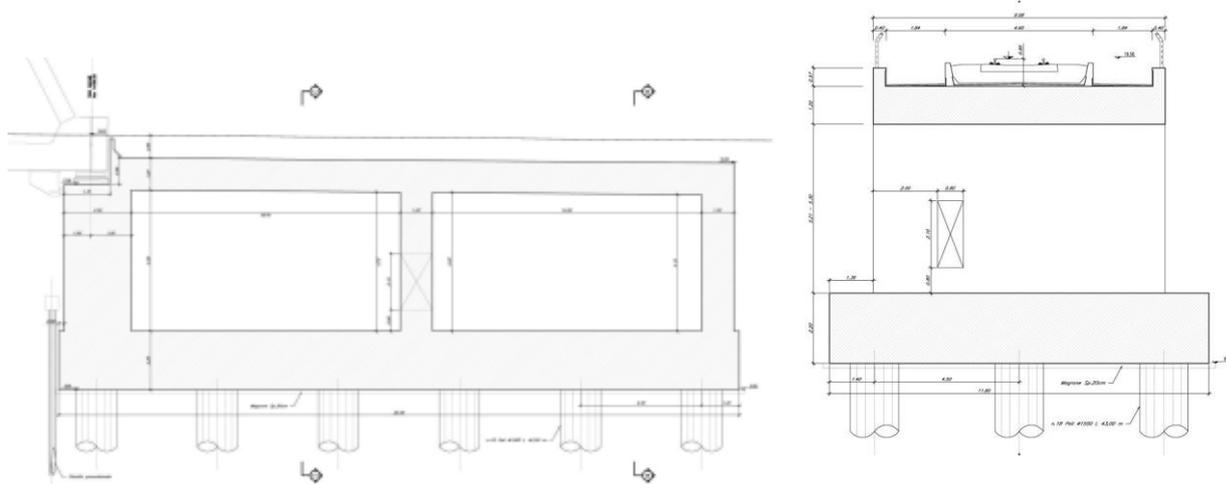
Sezione longitudinale spalla (sinistra) e Sezione trasversale della spalla (destra)
